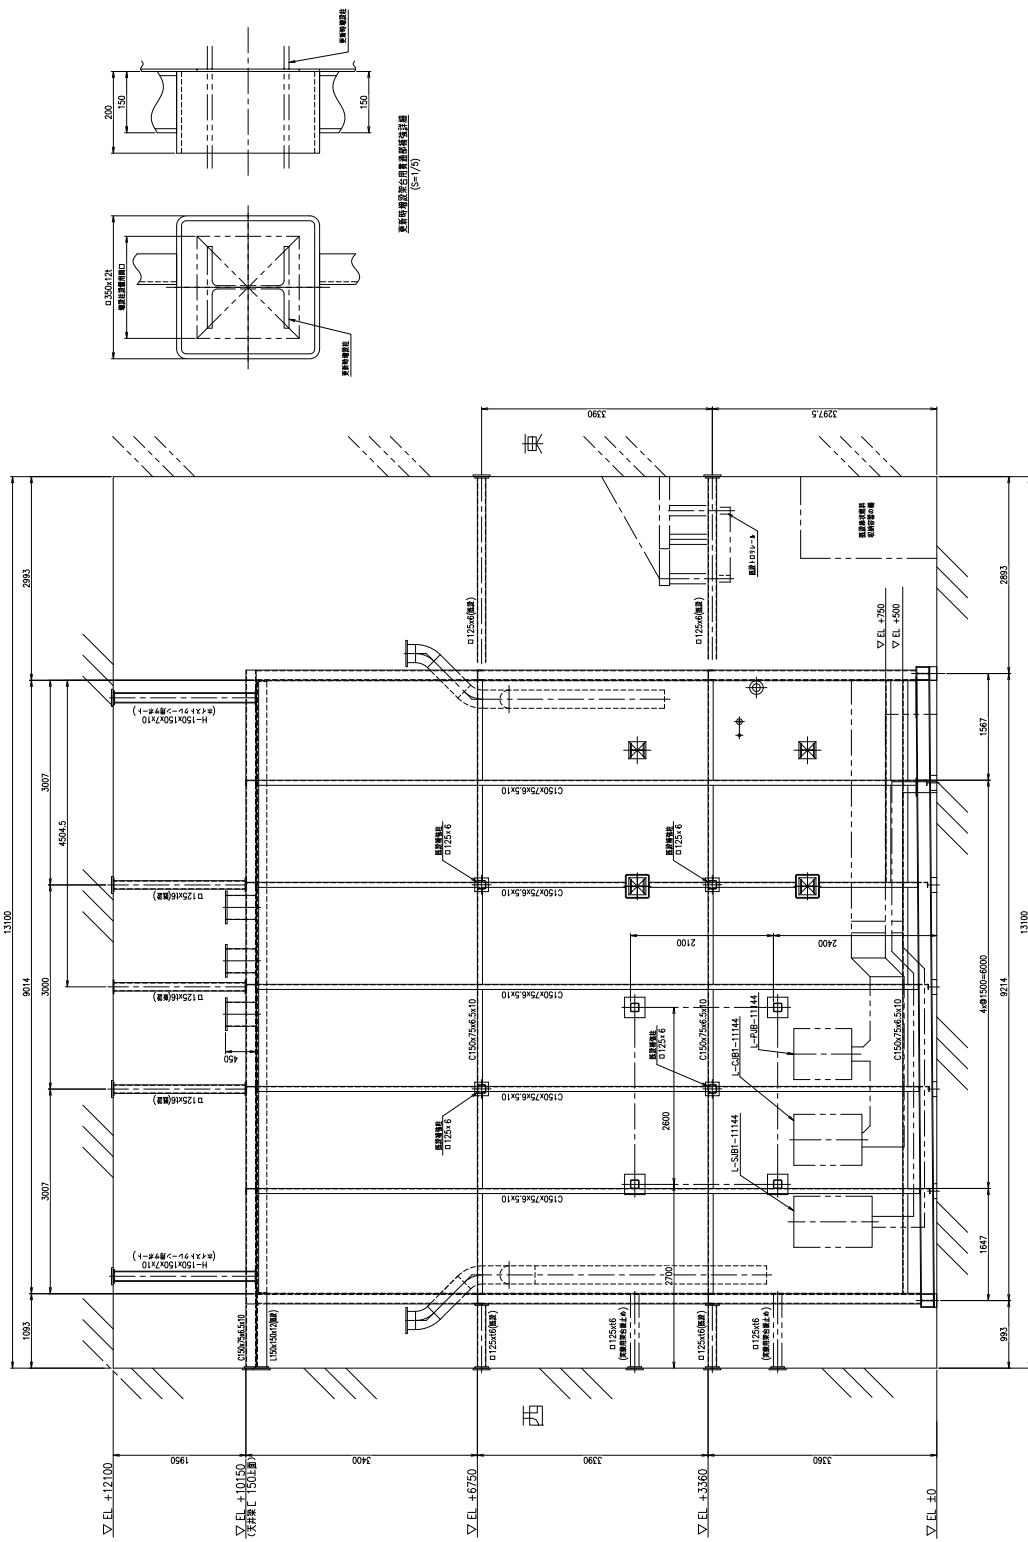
(8) 炉室フード改造図 (南側立面)
